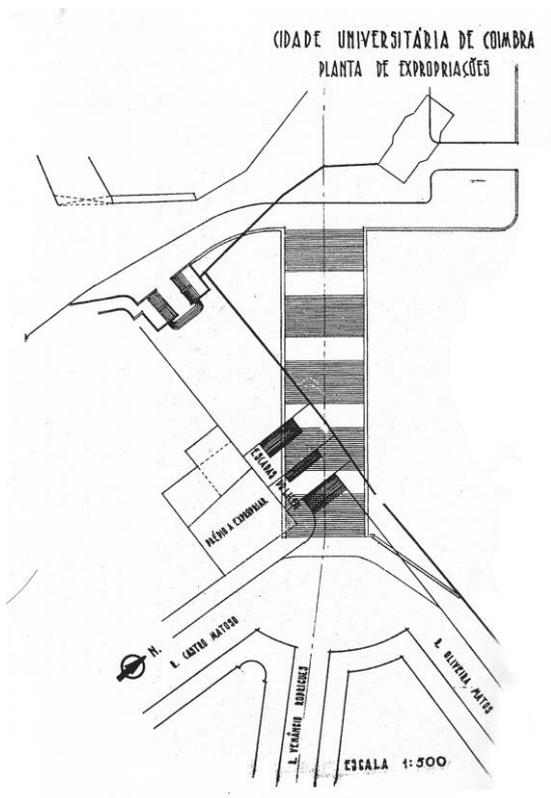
Planta de demolição das escadas existentes para a construção da Escadaria Monumental.
